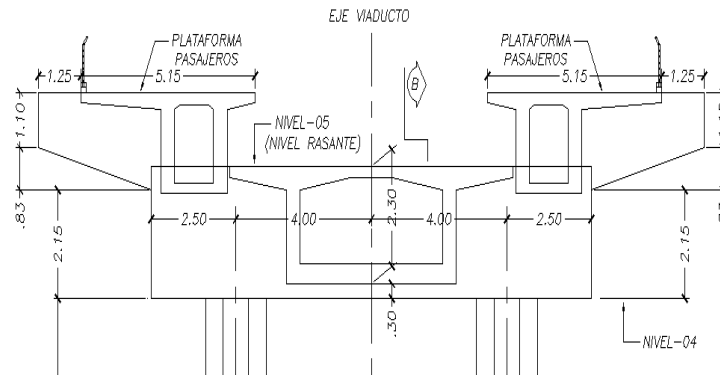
Sección transversal en Viga Cabezal en Pilares S49
